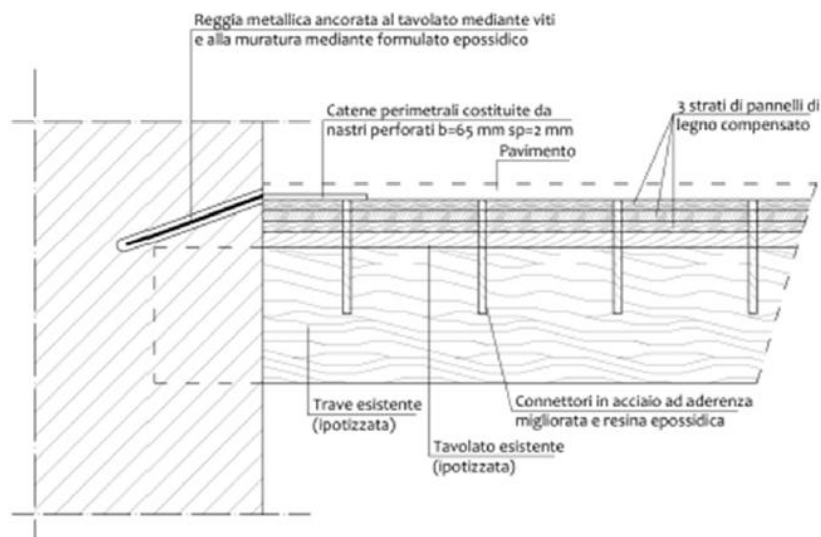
Schematizzazione del posizionamento della reggia metallica in sezione longitudinale del solaio.
